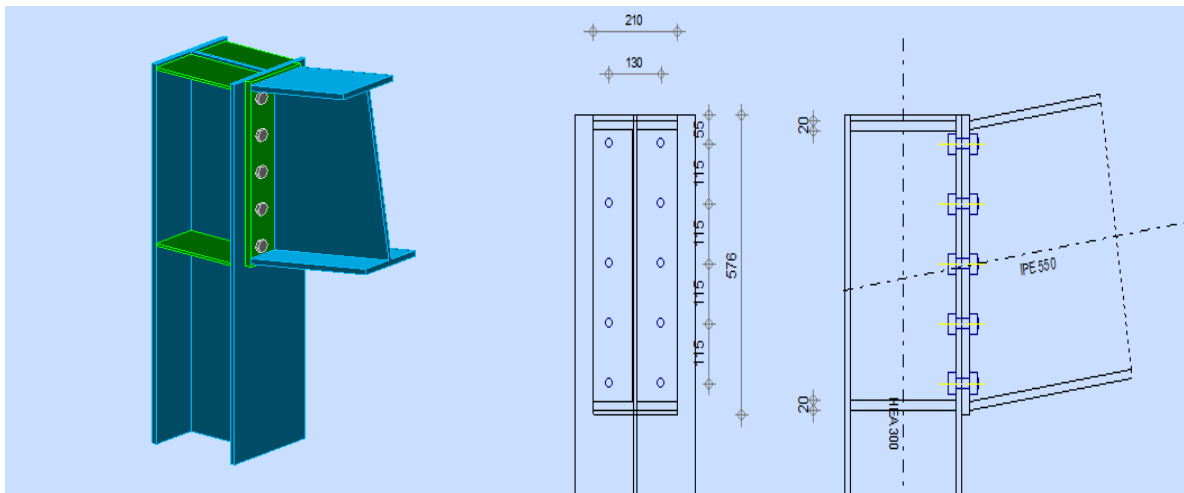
1 : Assemblage 3D poteau - traverse (HEA300 – IPE550)
